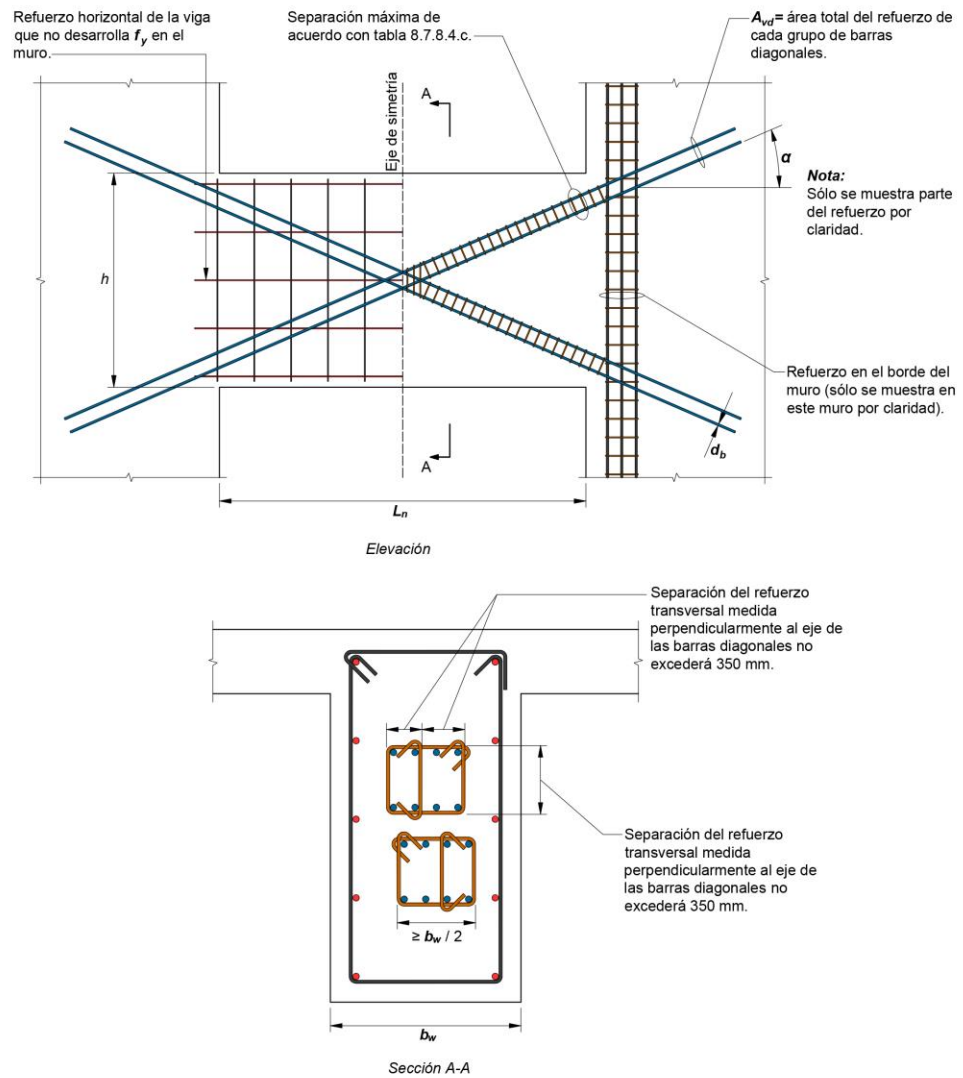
a – Confinamiento de barras diagonales en vigas de acoplamiento de ductilidad alta con refuerzo diagonal. Por claridad, sólo se muestra el refuerzo longitudinal del elemento de borde de un lado (adaptada de ACI CODE-318-19)
